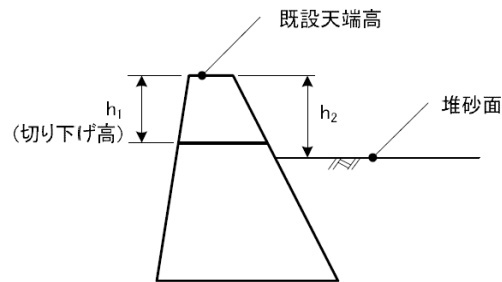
未満砂の砂防堰堤（未満砂状態）
